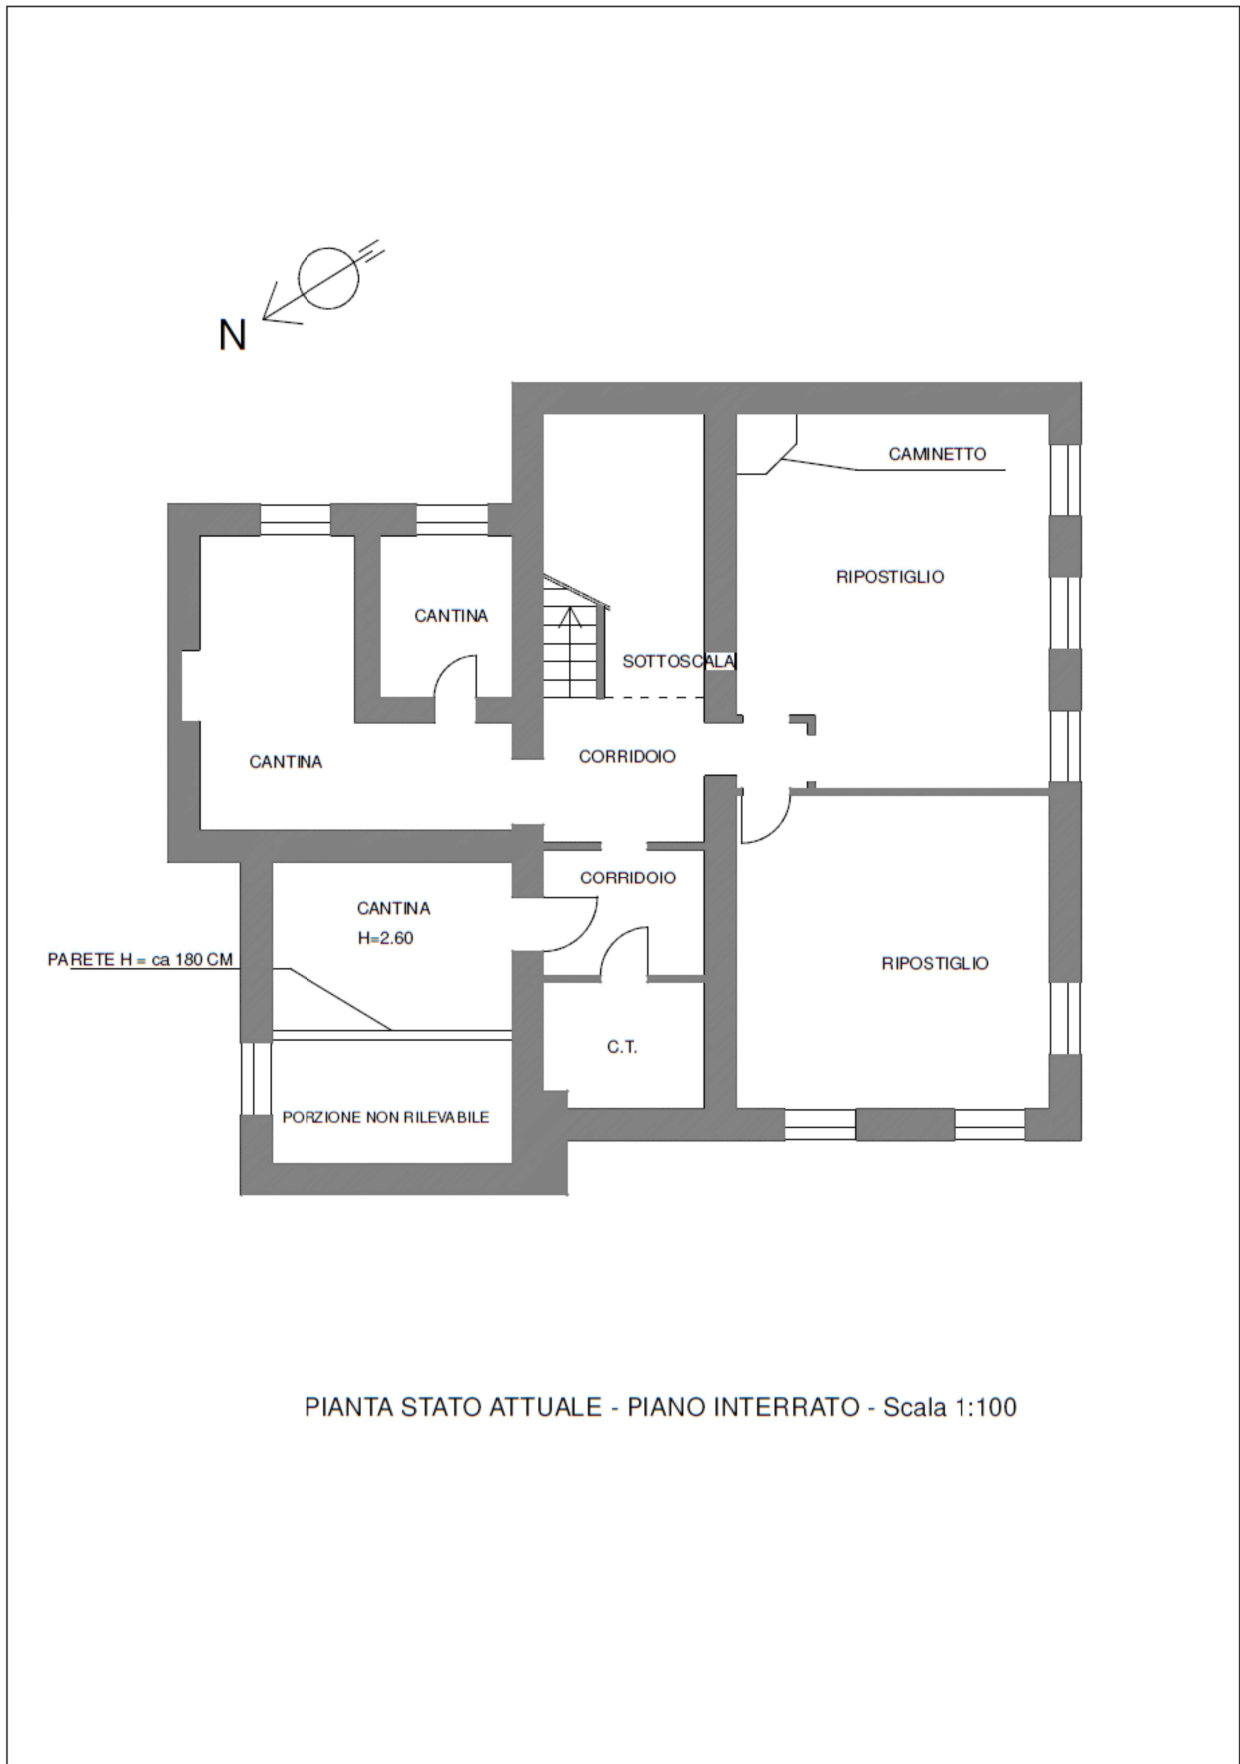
Planimetria immobili – da rilievo stato di fatto.
